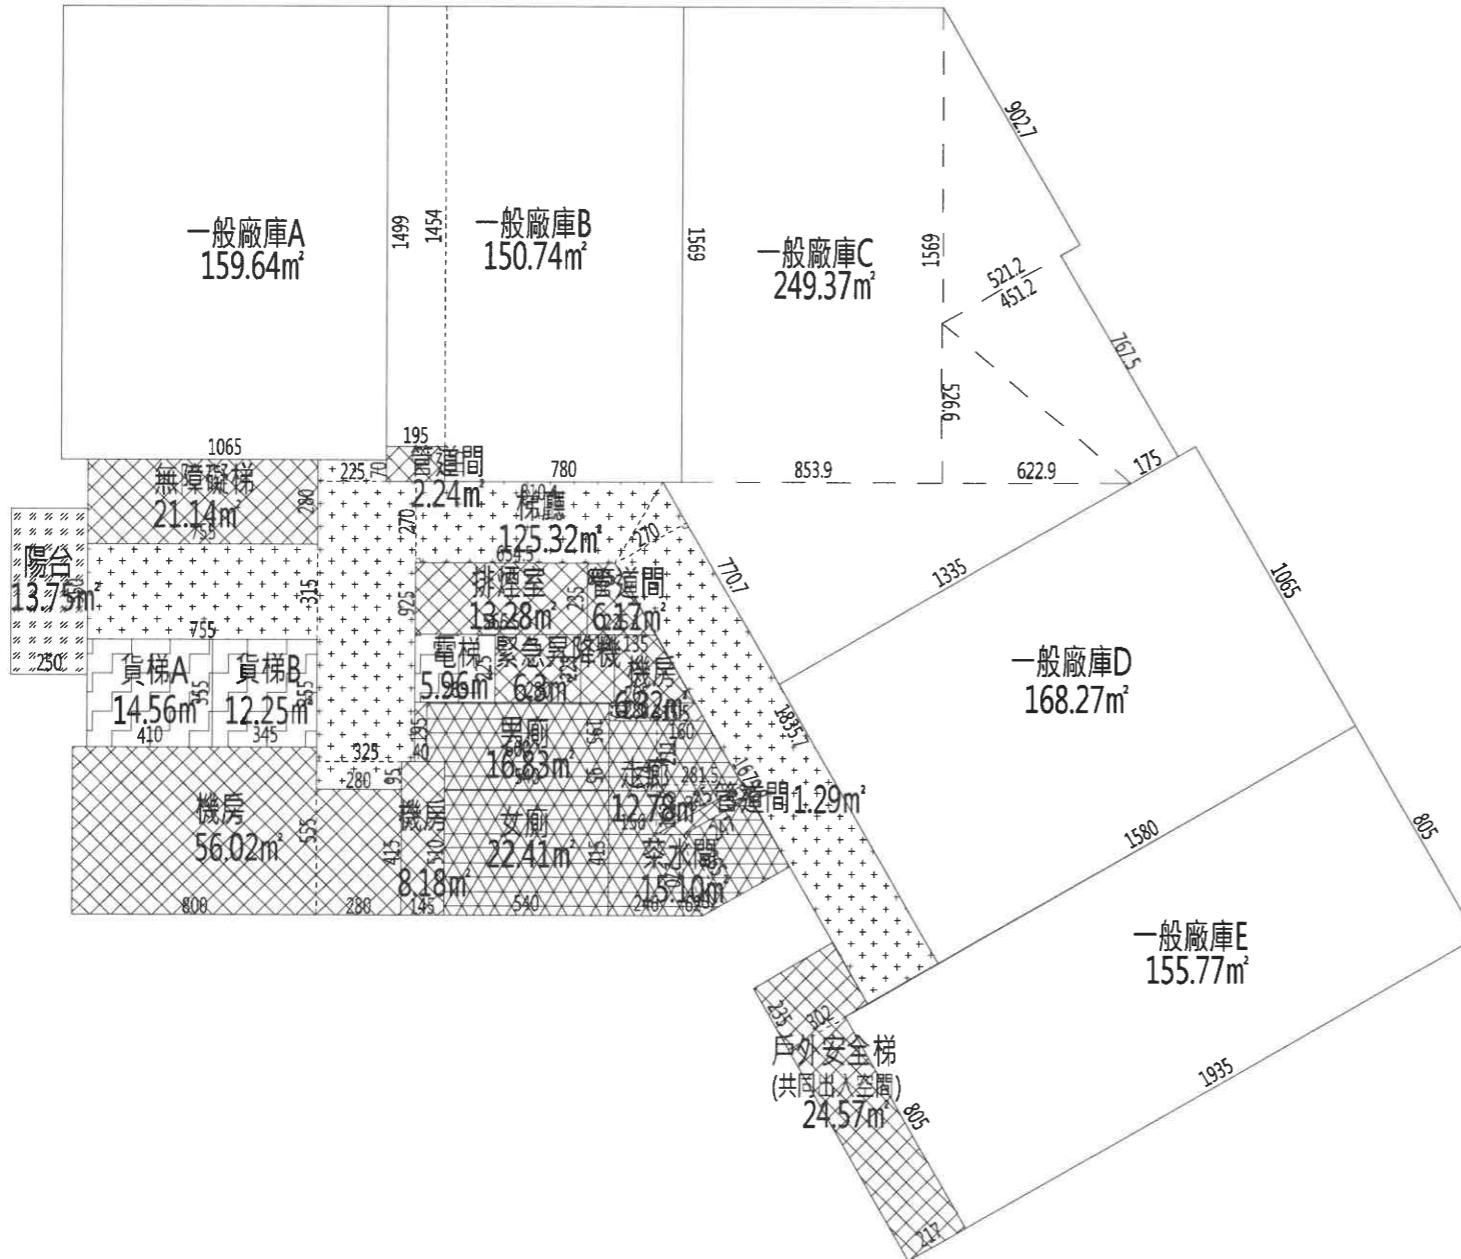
地上三層平面圖(維持原核定)(S : 1/300)
